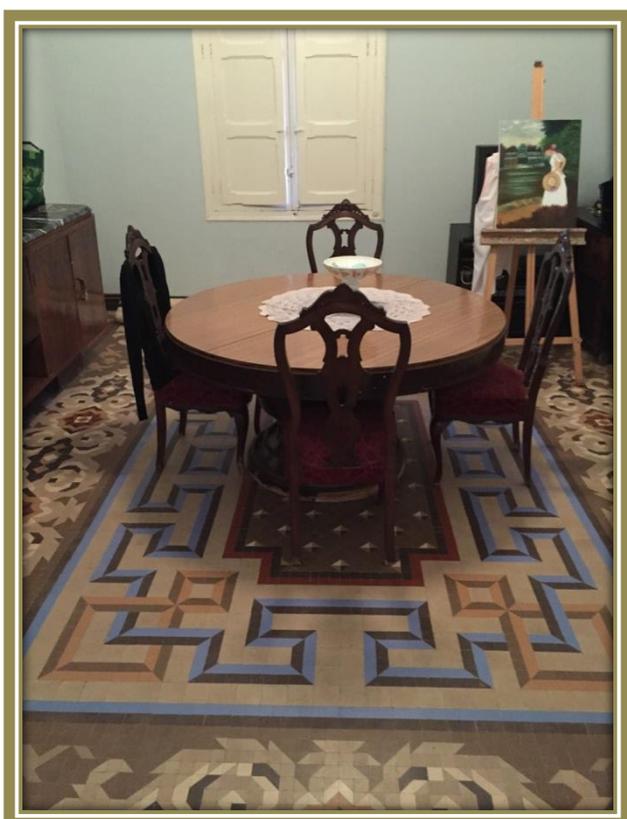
Tomada a una habitación tipo de Planta Primera.
